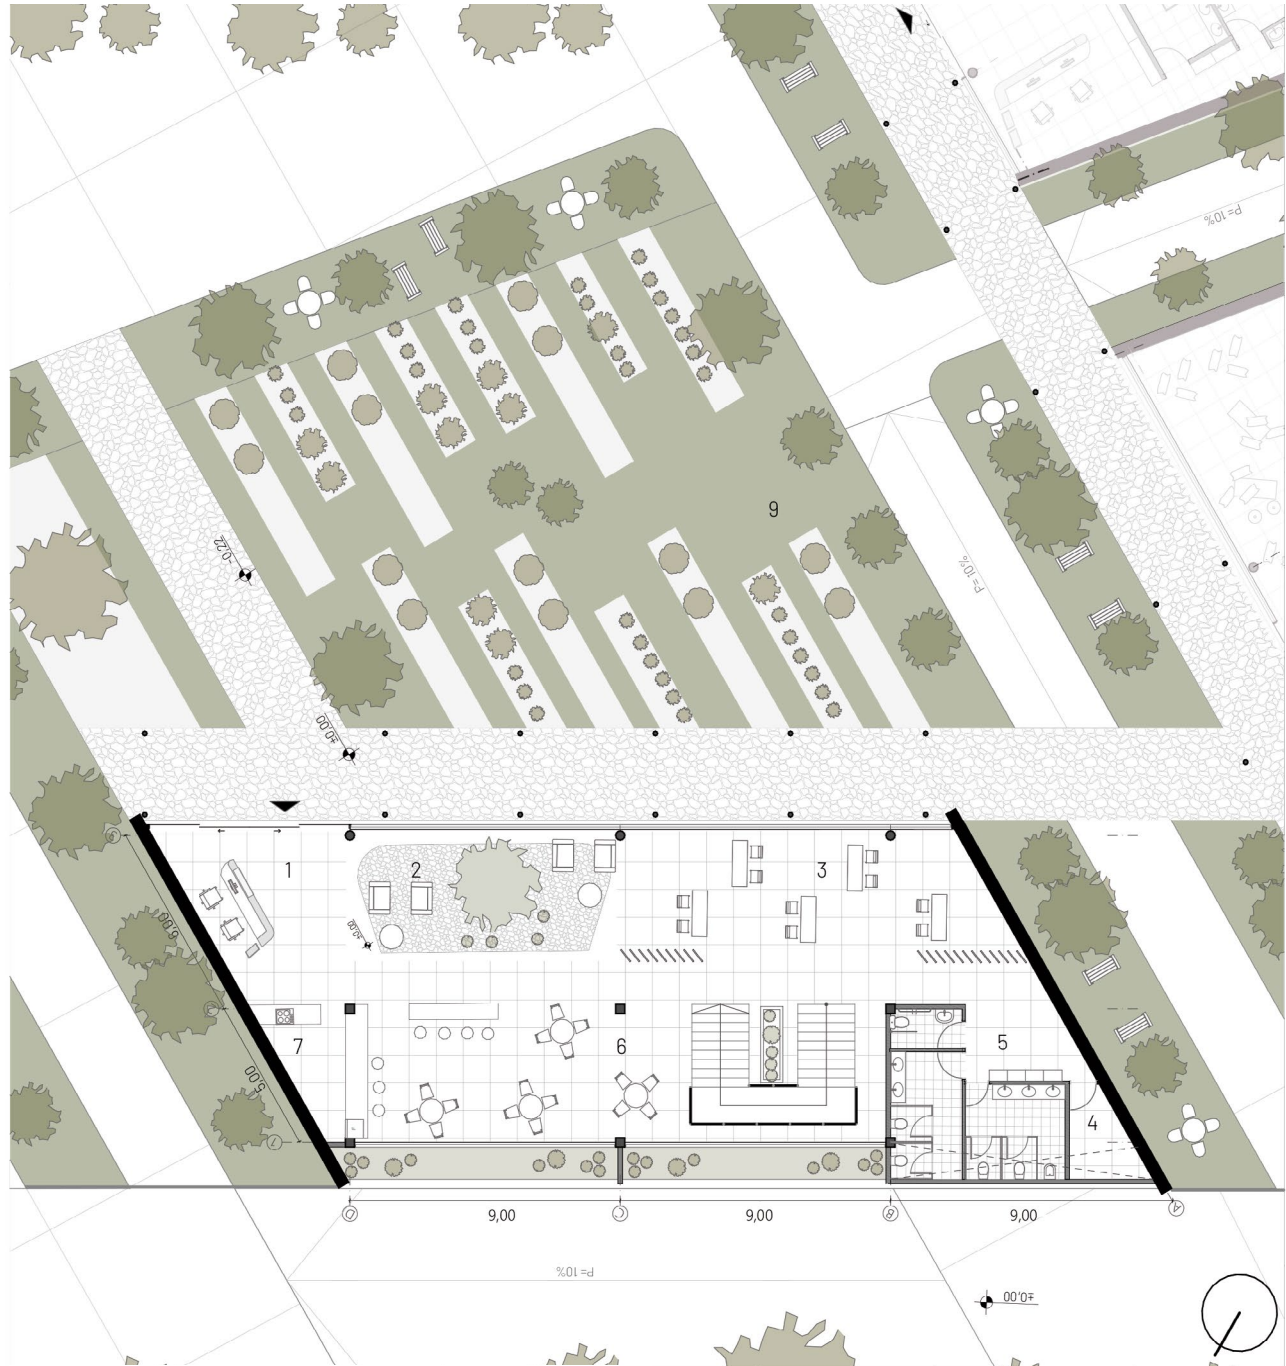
| Planta Baja | Fuente: Autoría propia. (2023).
